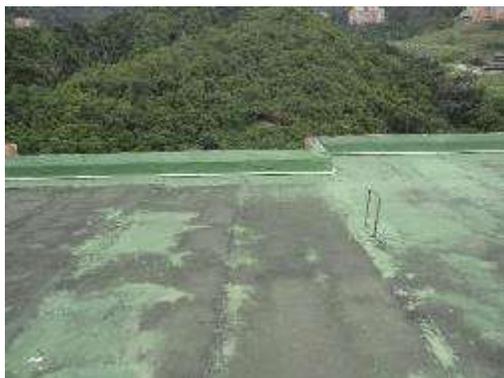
Planta techo, estado actual impermeabilización 1. Torre H. Fuente FF
